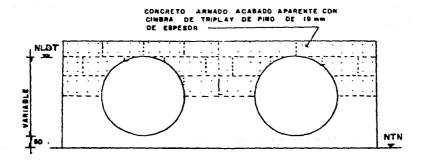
ETAPA 2 DE LA CONSTRUCCION DE LOS APOYOS
